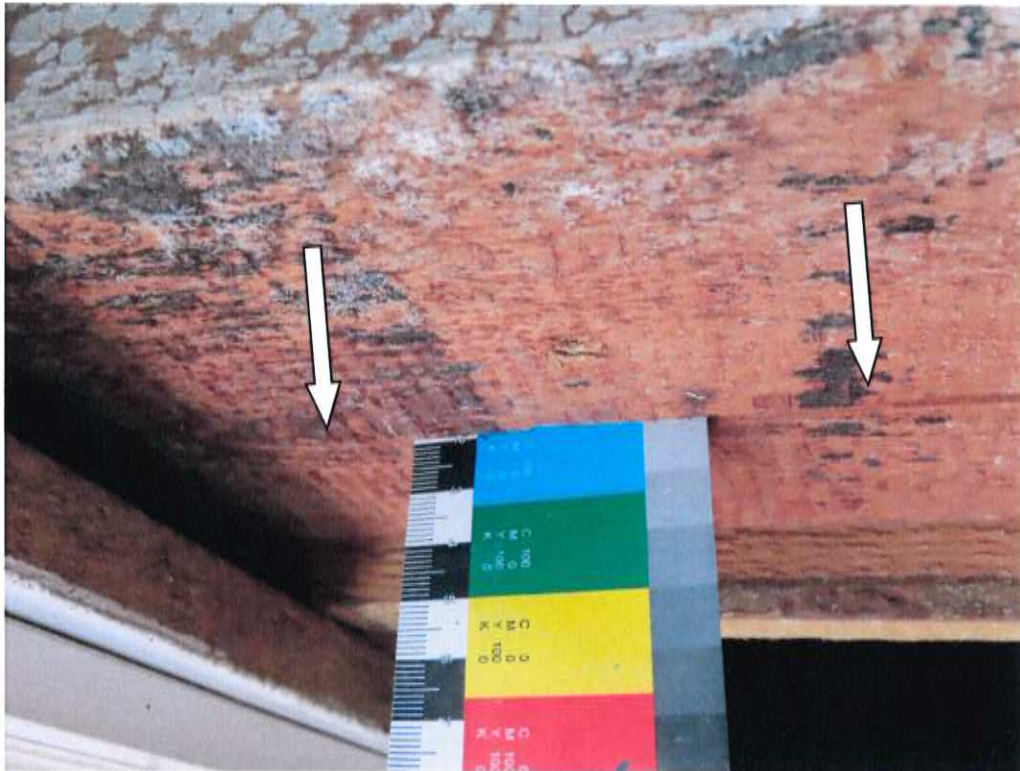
Holz-Wellstegträger: Detailaufnahme Längsriß nach Foto 24 mit ca. 20 mm Tiefe
